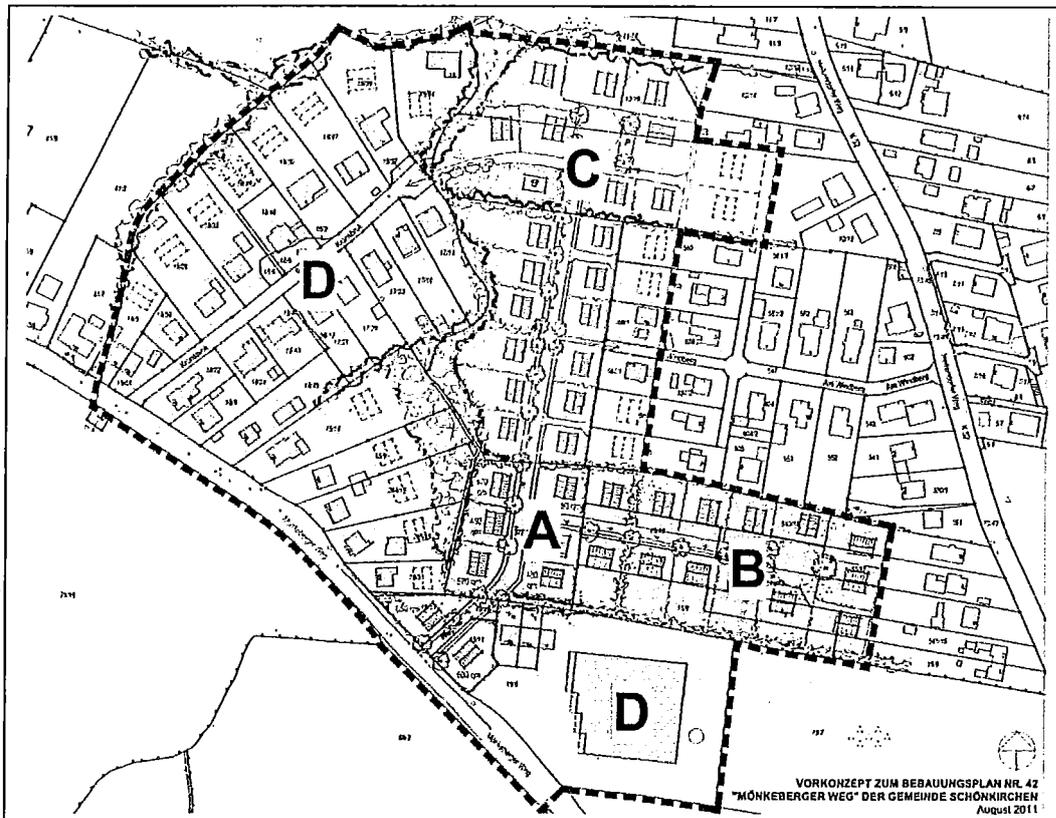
Vorkonzept zum Gesamtbebauungsplan Nr. 42
